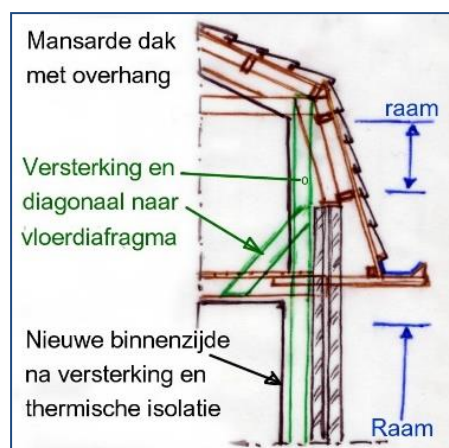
De twee dakhellingen moet afzonderlijk verstijfd worden. Dit kan door verbetering van het dakbeschot of door toepassing van montage strips of spankabels.
